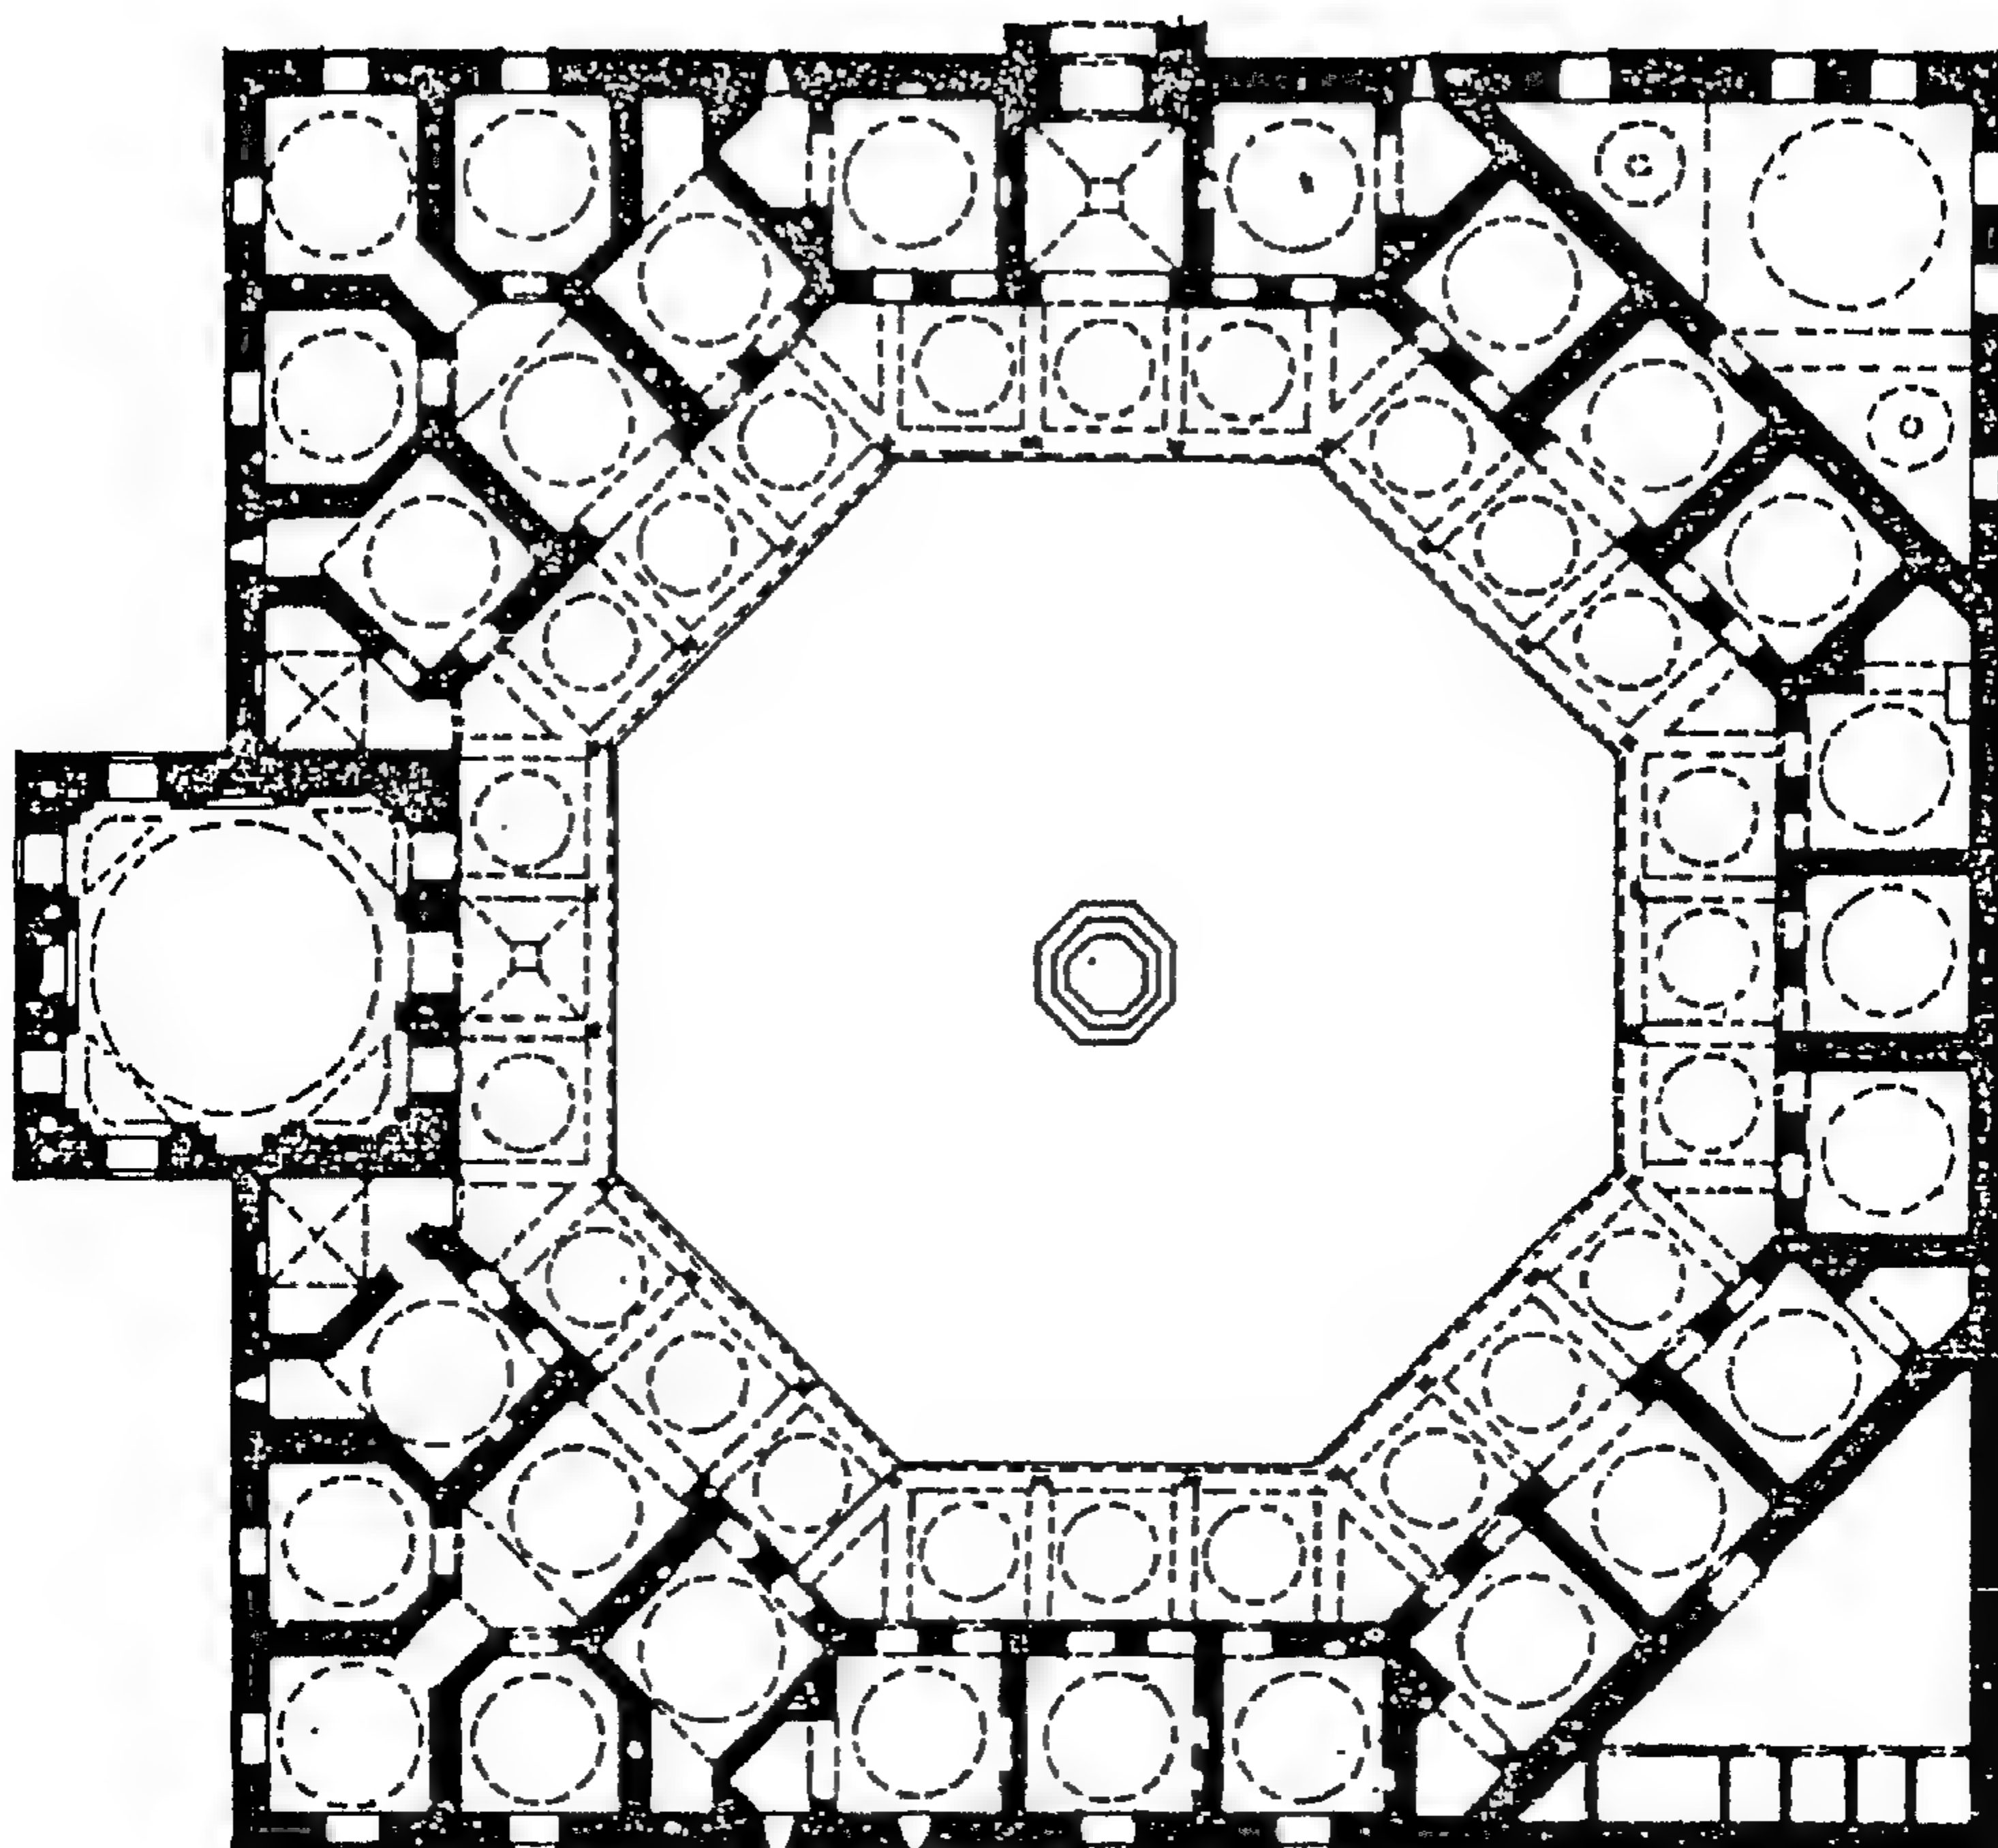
مسقط أفقي لمدرسة سليمان باشا في أزنيق - (عن : Goodwin) .
